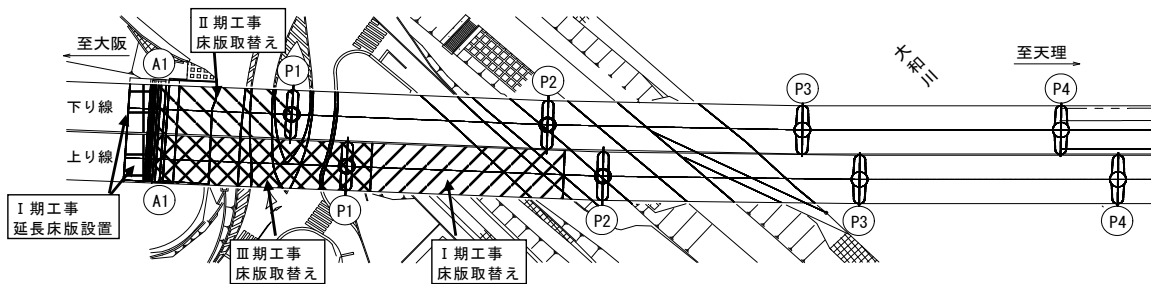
御幸大橋の工事概要平面図⁵⁾
